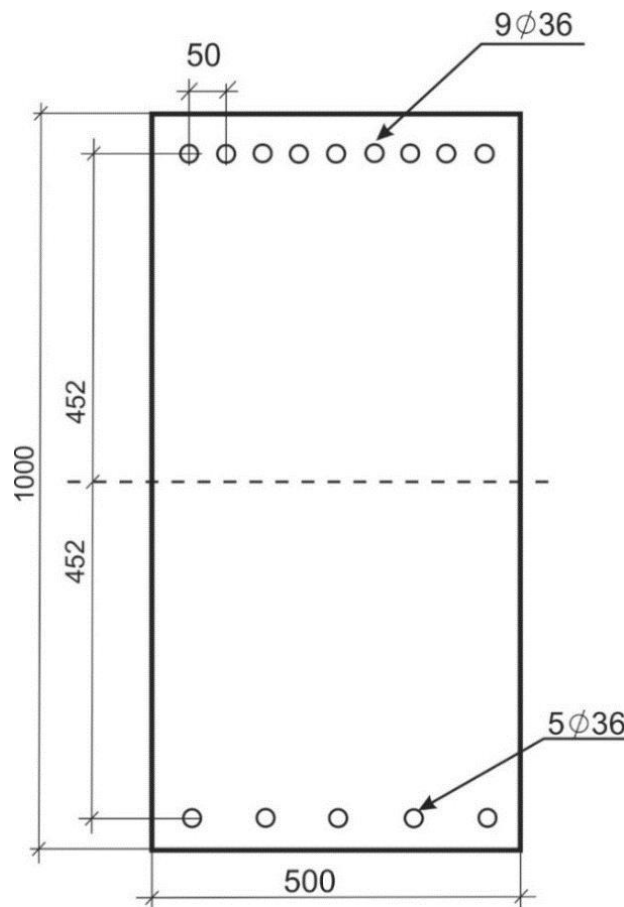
Армуння перерізу ІІ балки-перемички
